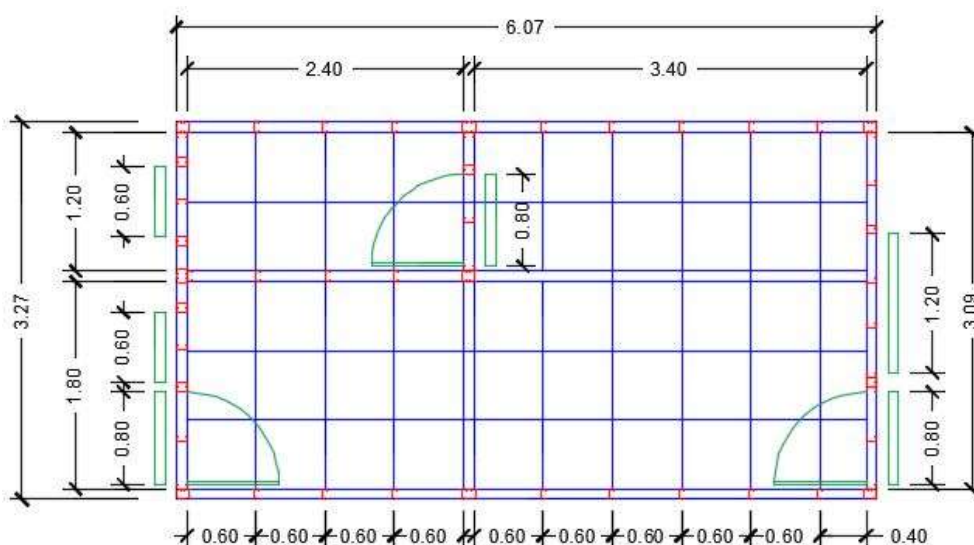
Planta do piso térreo em LSF – sem escala. Fonte: Autor (2017).
